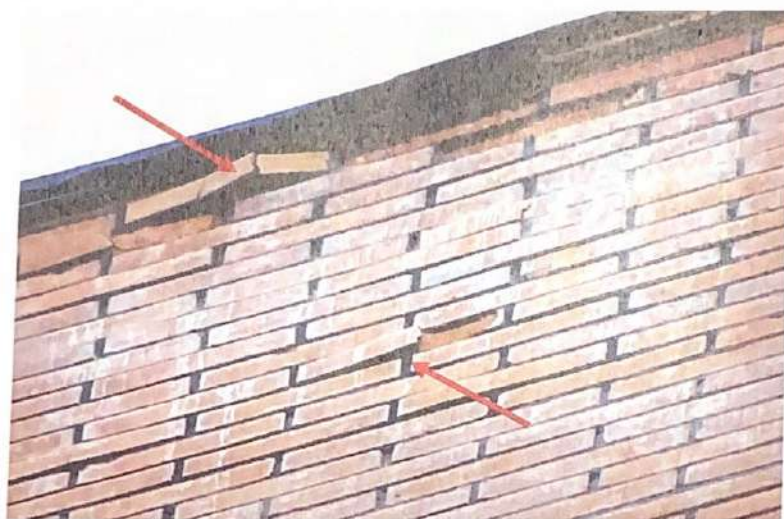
Секция 9. Фасад 1. Критические поверхностные разрушения кирпича подпарапетной зоны.
